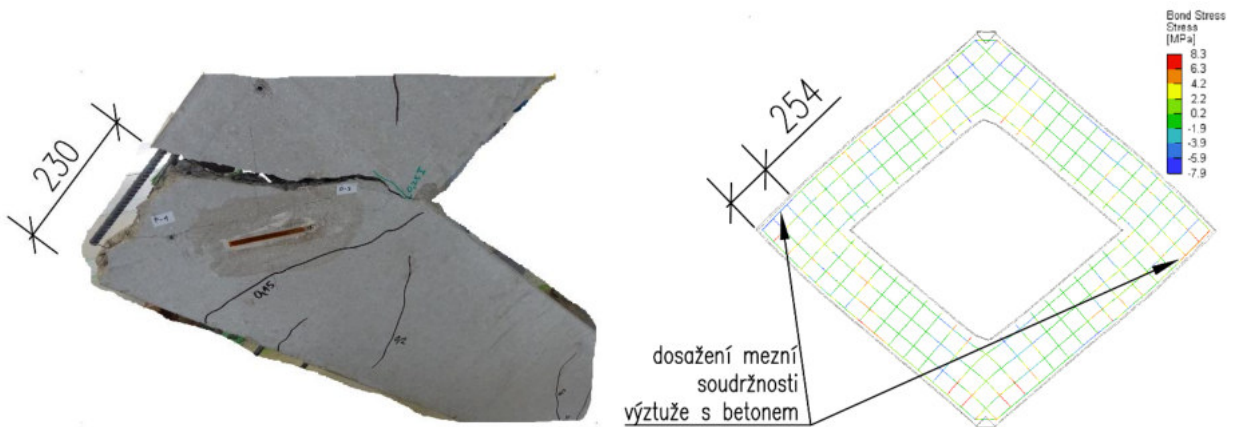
Porušení vzorku SV4 (detail 2) – experiment
